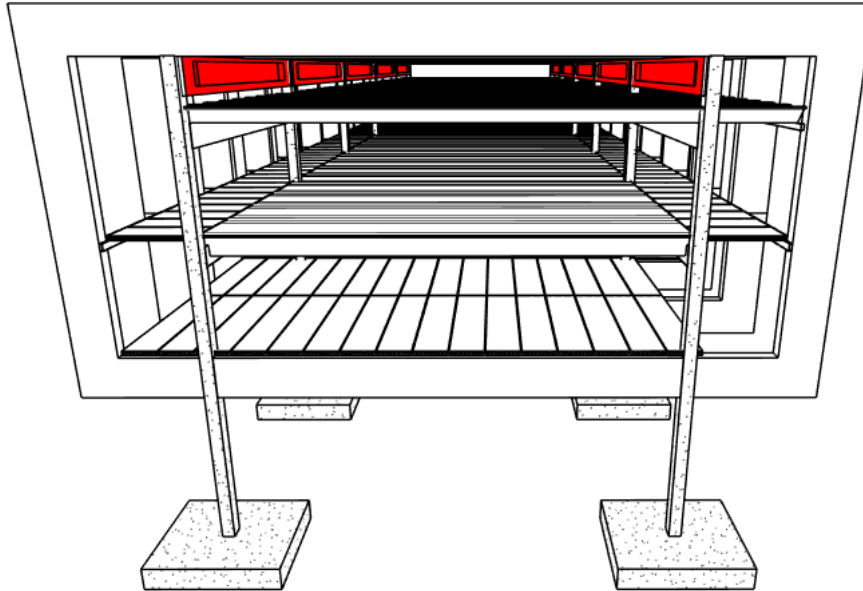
Ubicación de vigas pretensadas superiores. Fuente: Autor.
